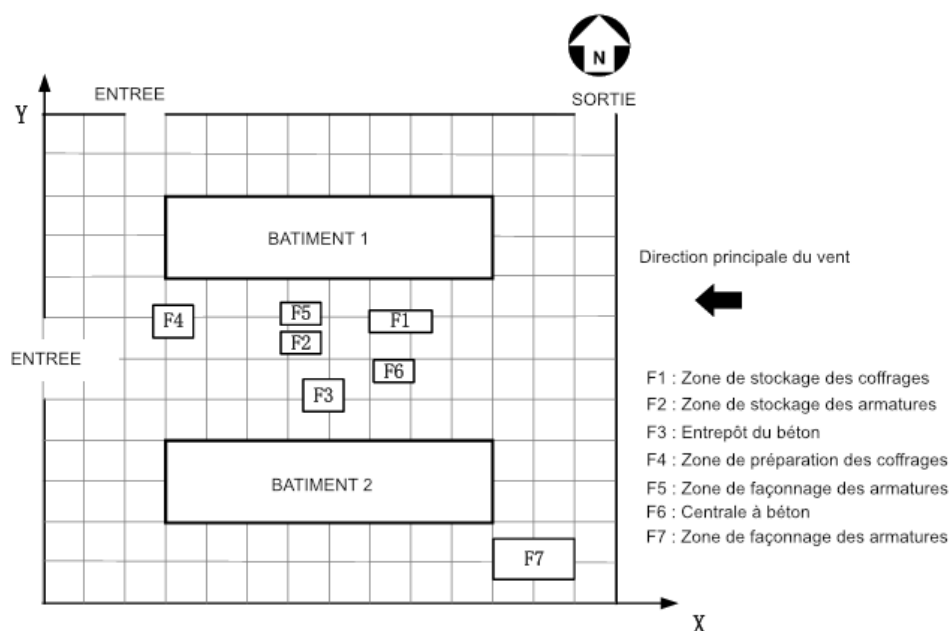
Plan optimisé d'implantation d'un chantier visant à réduire l'exposition aux poussières de construction.
